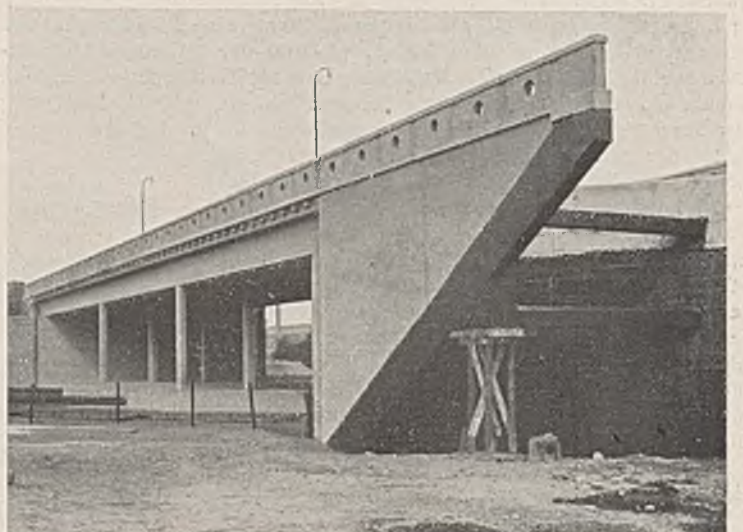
Brücke nach Fertigstellung der Betonarbeiten.
